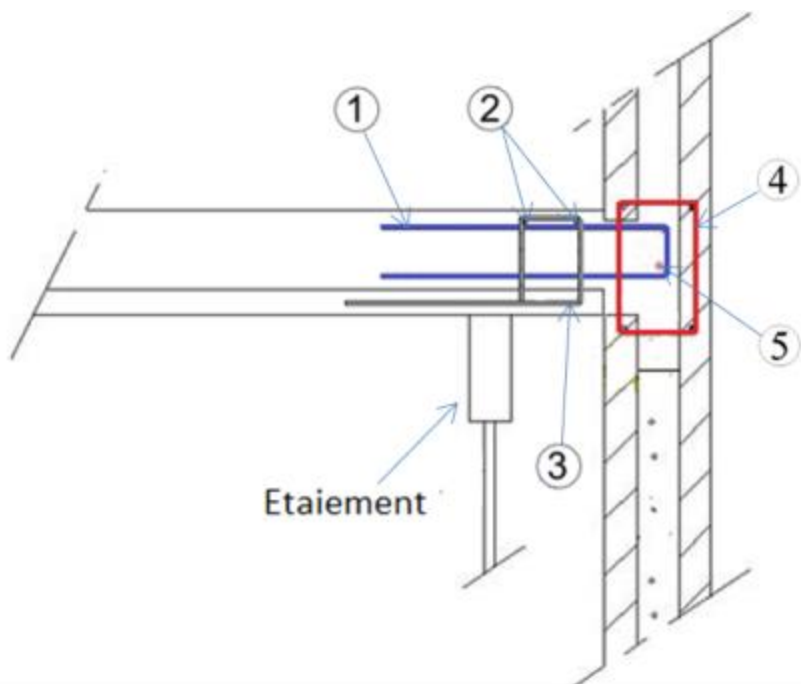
Dispositions constructives sur appui des poutres ou poutres voiles réalisées à partir de « Prémur KP1 »
